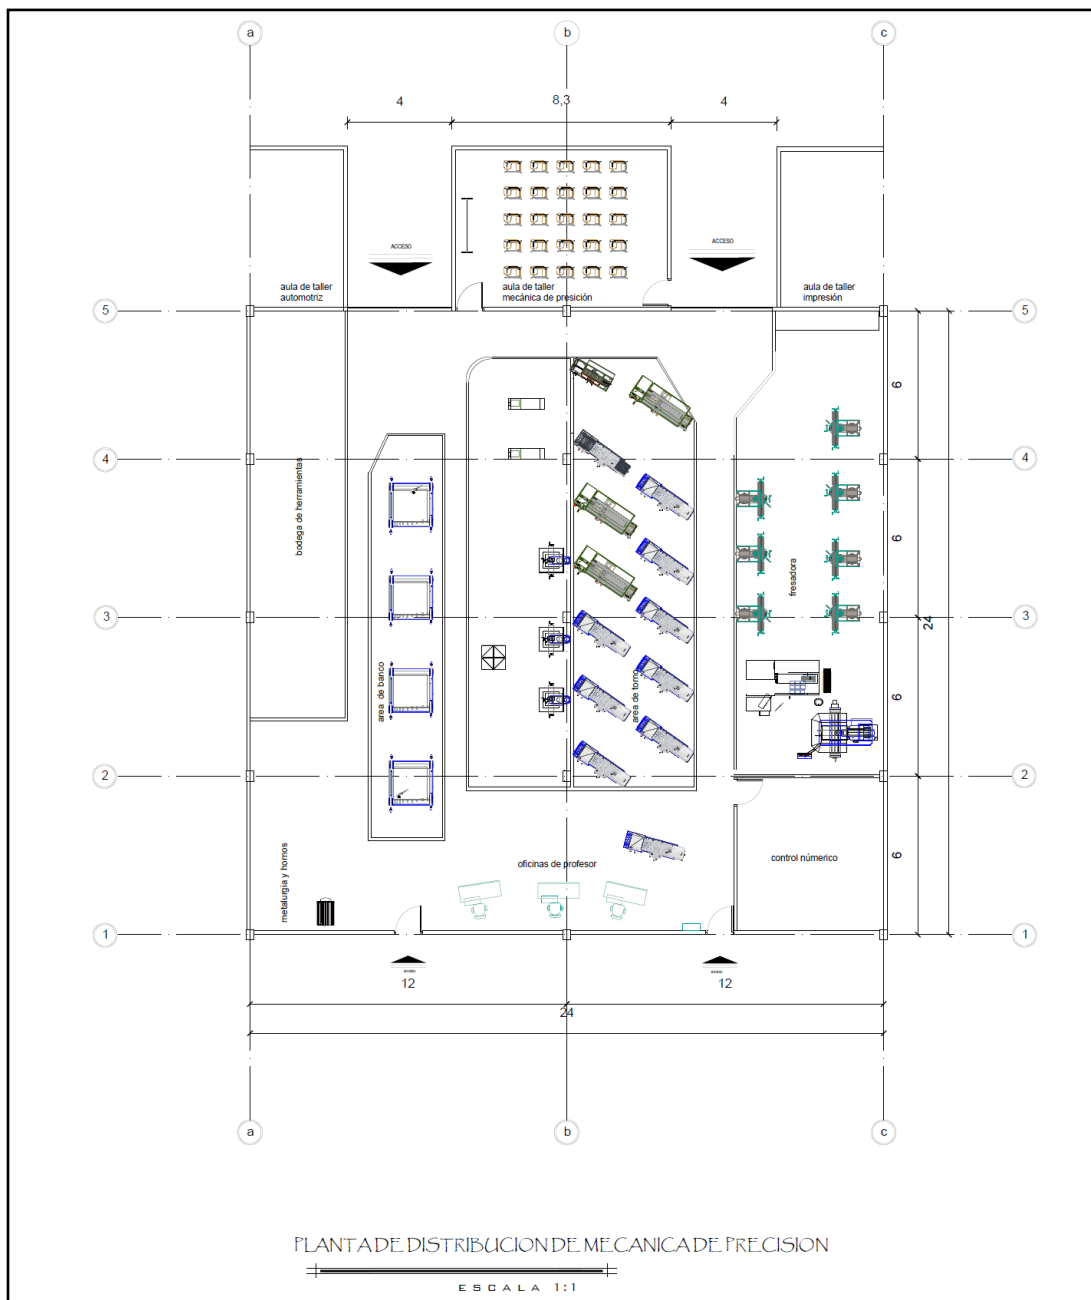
Plano Levantamiento planta física del taller de Mecánica de Precisión
